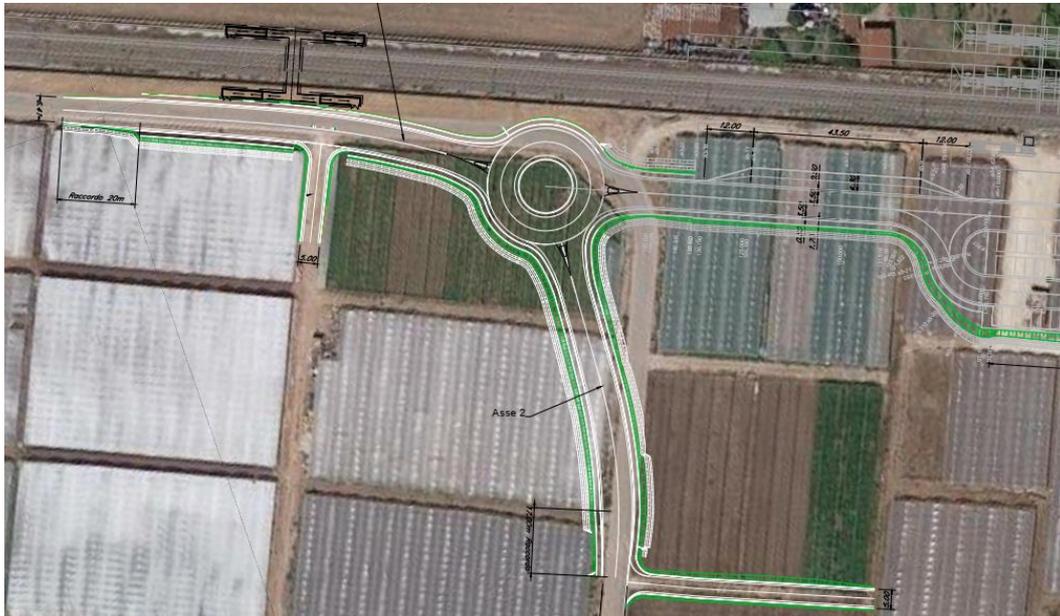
Stralcio planimetrico – NV05B\_ Nuova rotondina su strada locale e riprofilatura rami di innesto
